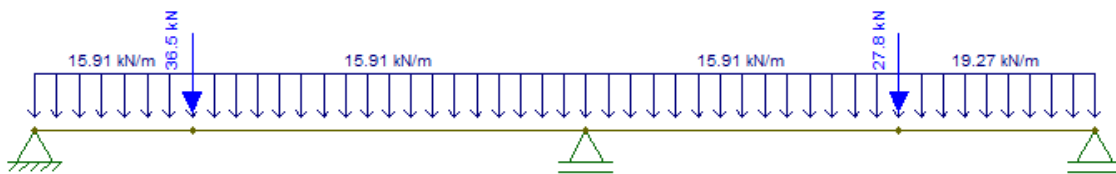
Esquema estrutural - Viga 8 (a e b) (Tipo).
